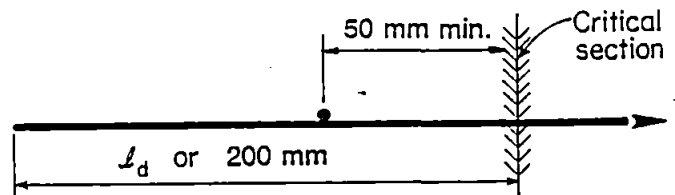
Longitud de desarrollo de la malla electrosoldada de alambre estriado.
